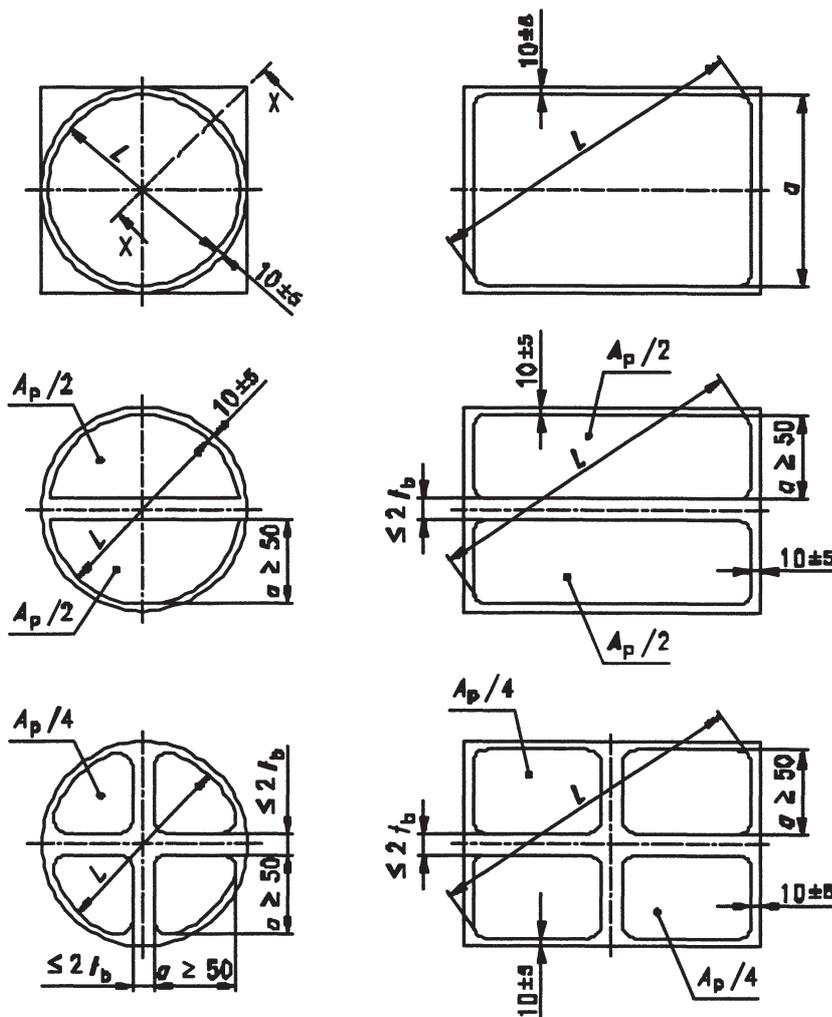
Beispiele für die Ausbildung gekammerter ebener PTFE-Platten
